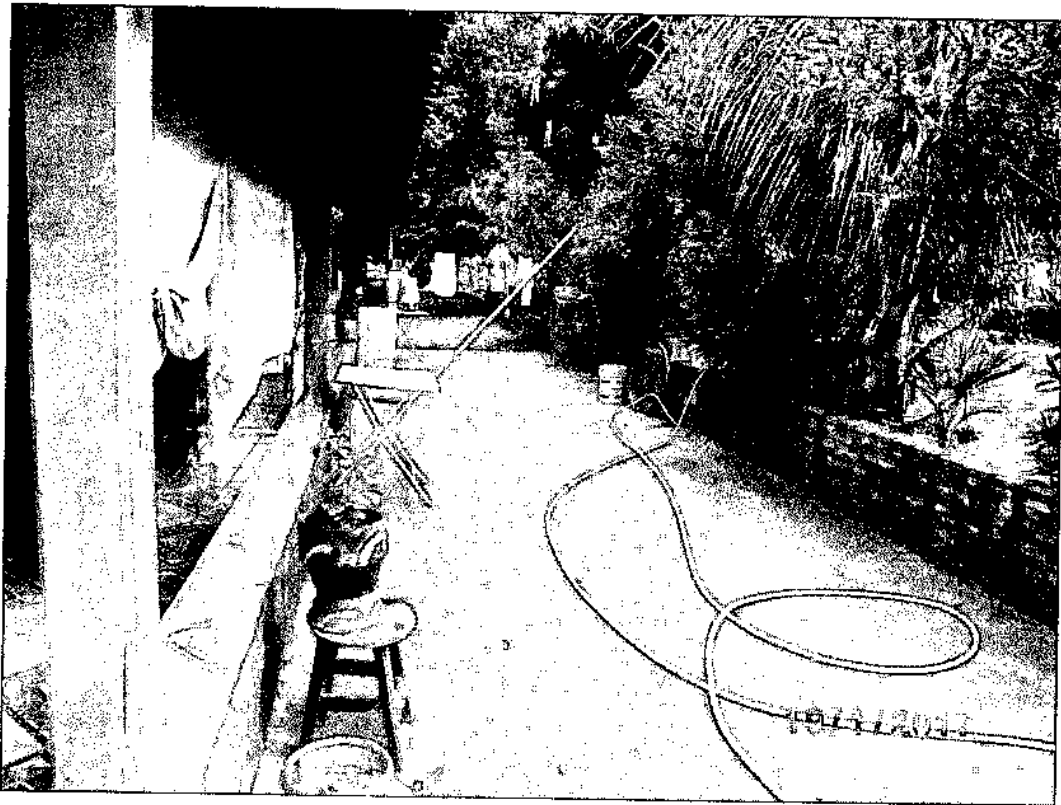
DETALHE DO PISO CIMENTADO, MURETA, GRAMADOS DA SEDE
